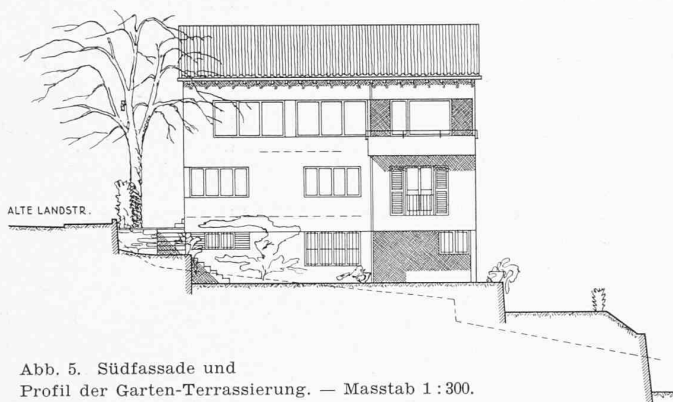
Südfassade und Profil der Garten-Terrassierung. — Masstab 1:300.
